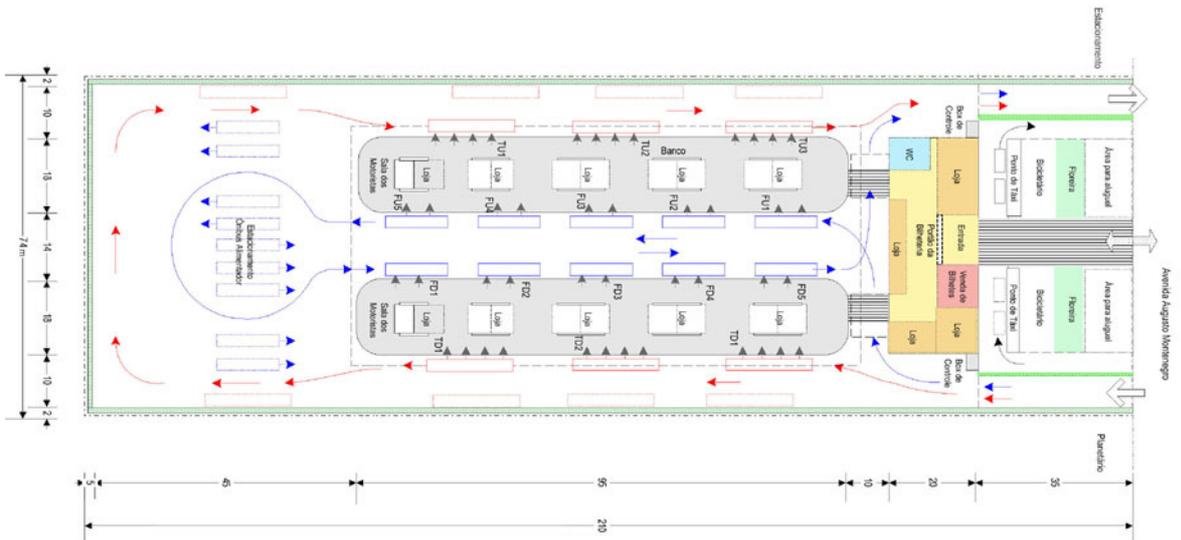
Localização e Planta do Terminal C: Mangueirão (sem escala)
